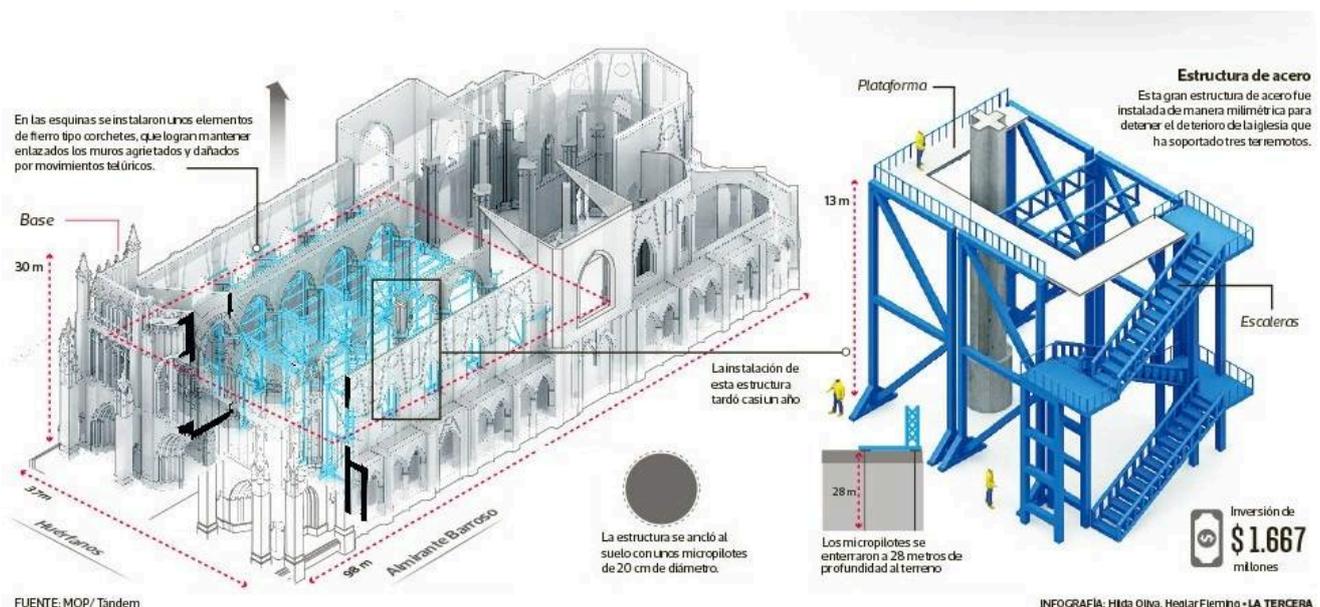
Proyecto de estabilización de la Basílica del Salvador.
